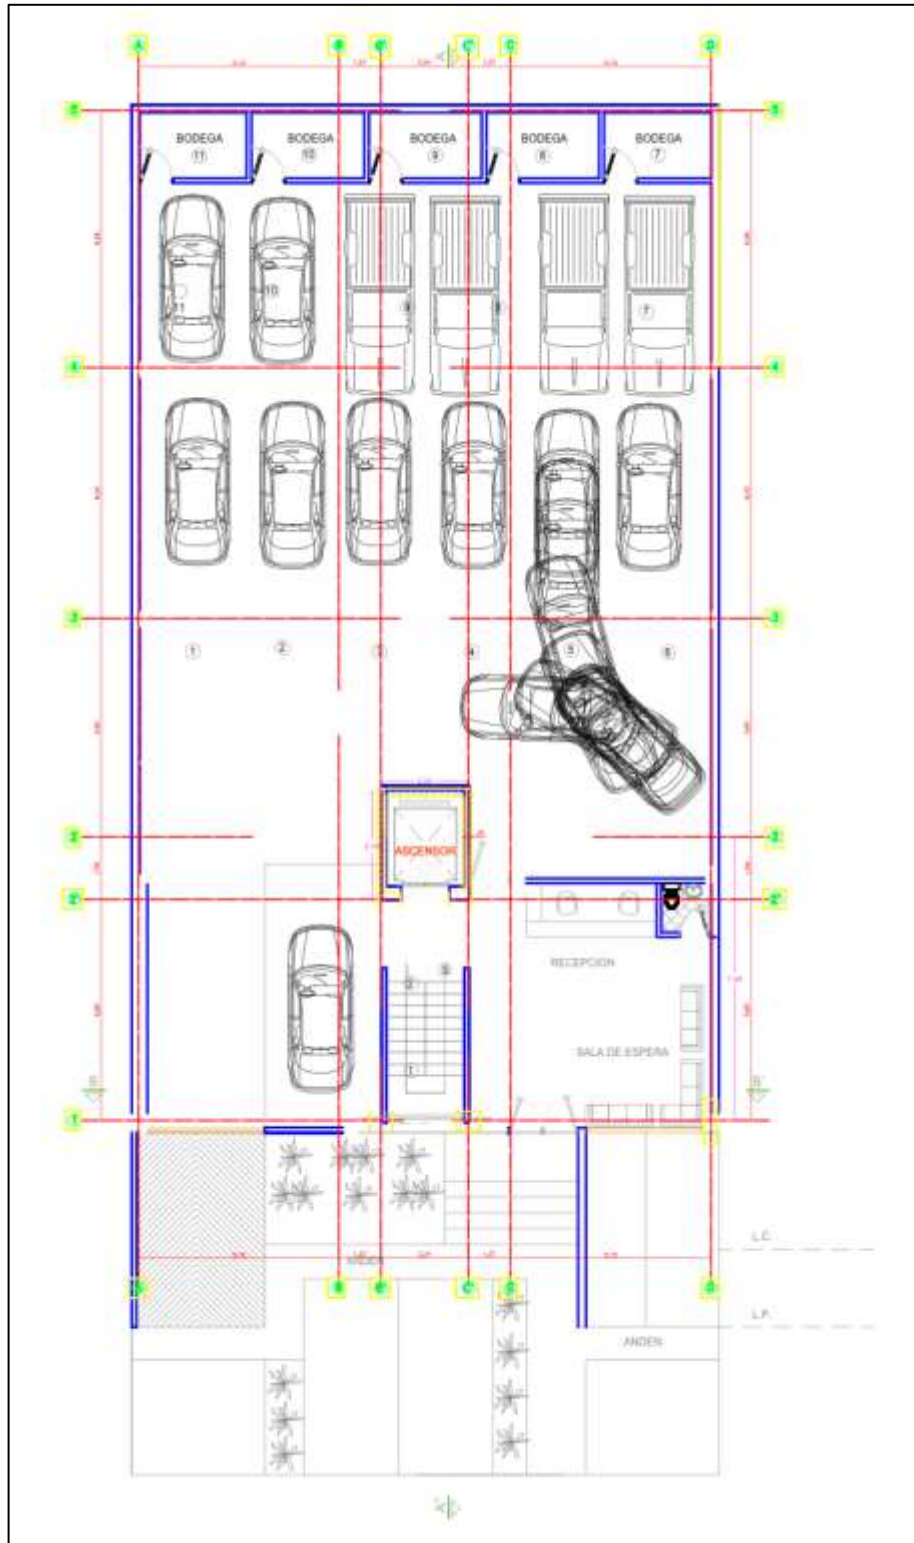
Planta primer piso de sótano de edificación objeto de estudio. Fuente: Planos arquitectónicos proporcionados por el Ingeniero Civil José España Moratto.
